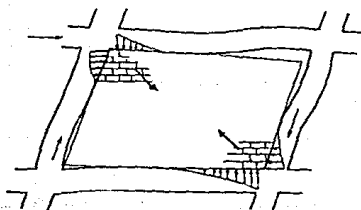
24 MURO DE MAMPONERÍA CONFINADO POR UN MARCO (REF. 7)
